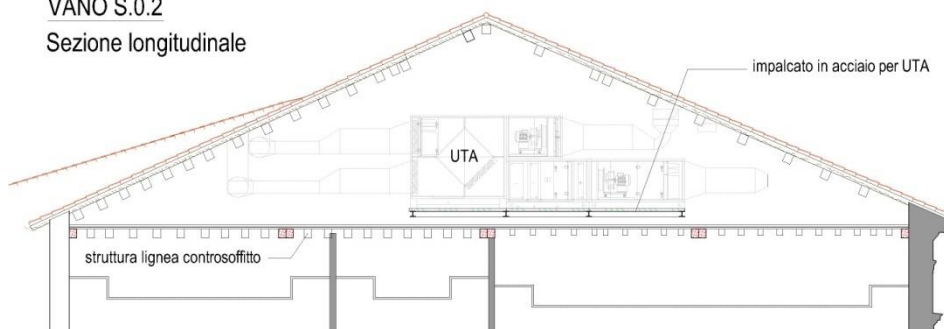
Localizzazione impalcato UTA nel sottotetto S.02 - sezione longitudinale
